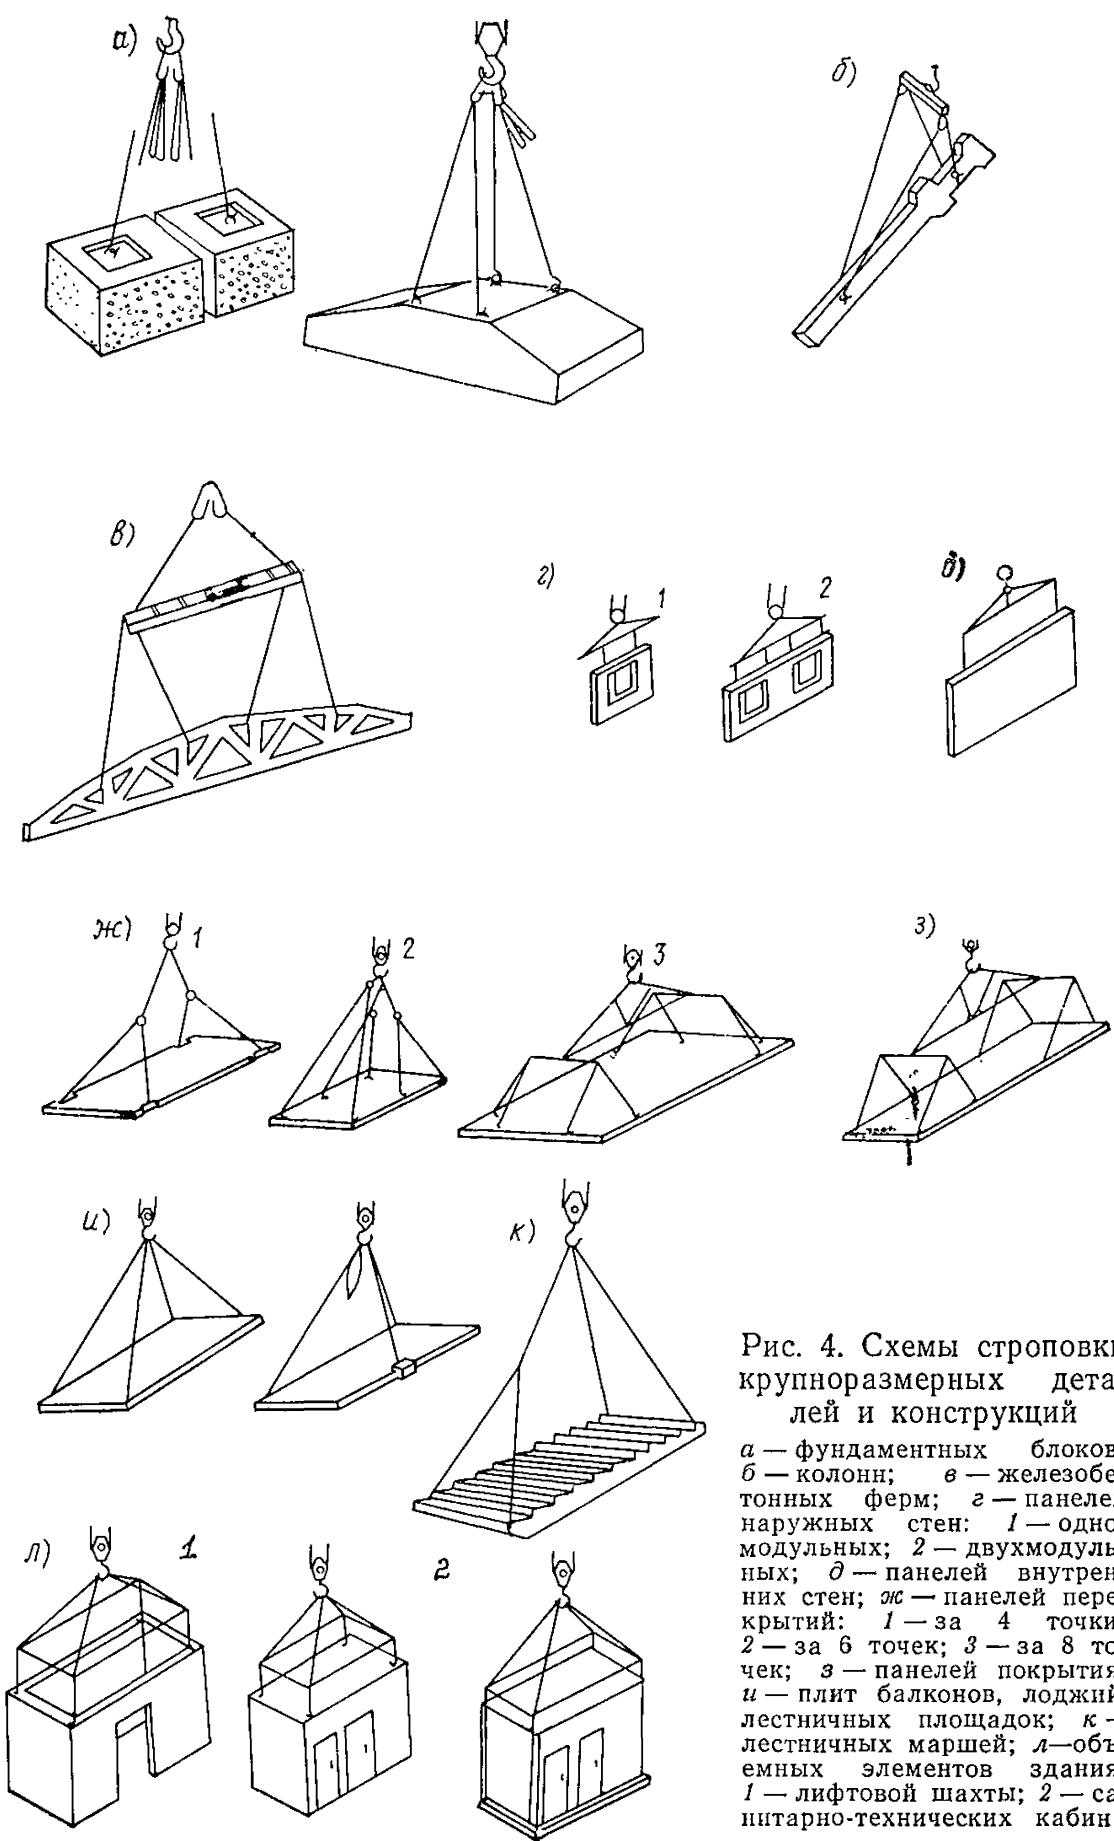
Схемы строповки крупноразмерных деталей и конструкций
